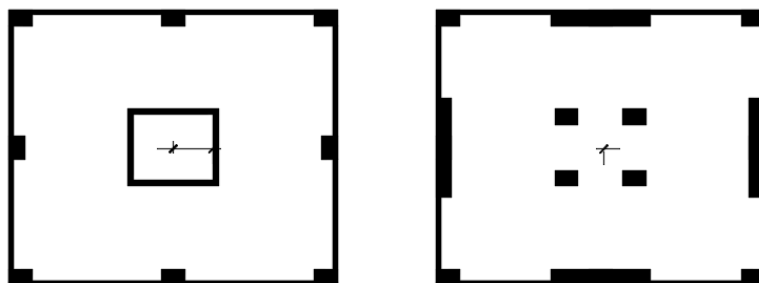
Formas de distribuição dos elementos estruturais verticais (adaptado de Lopes, M., 2008)
